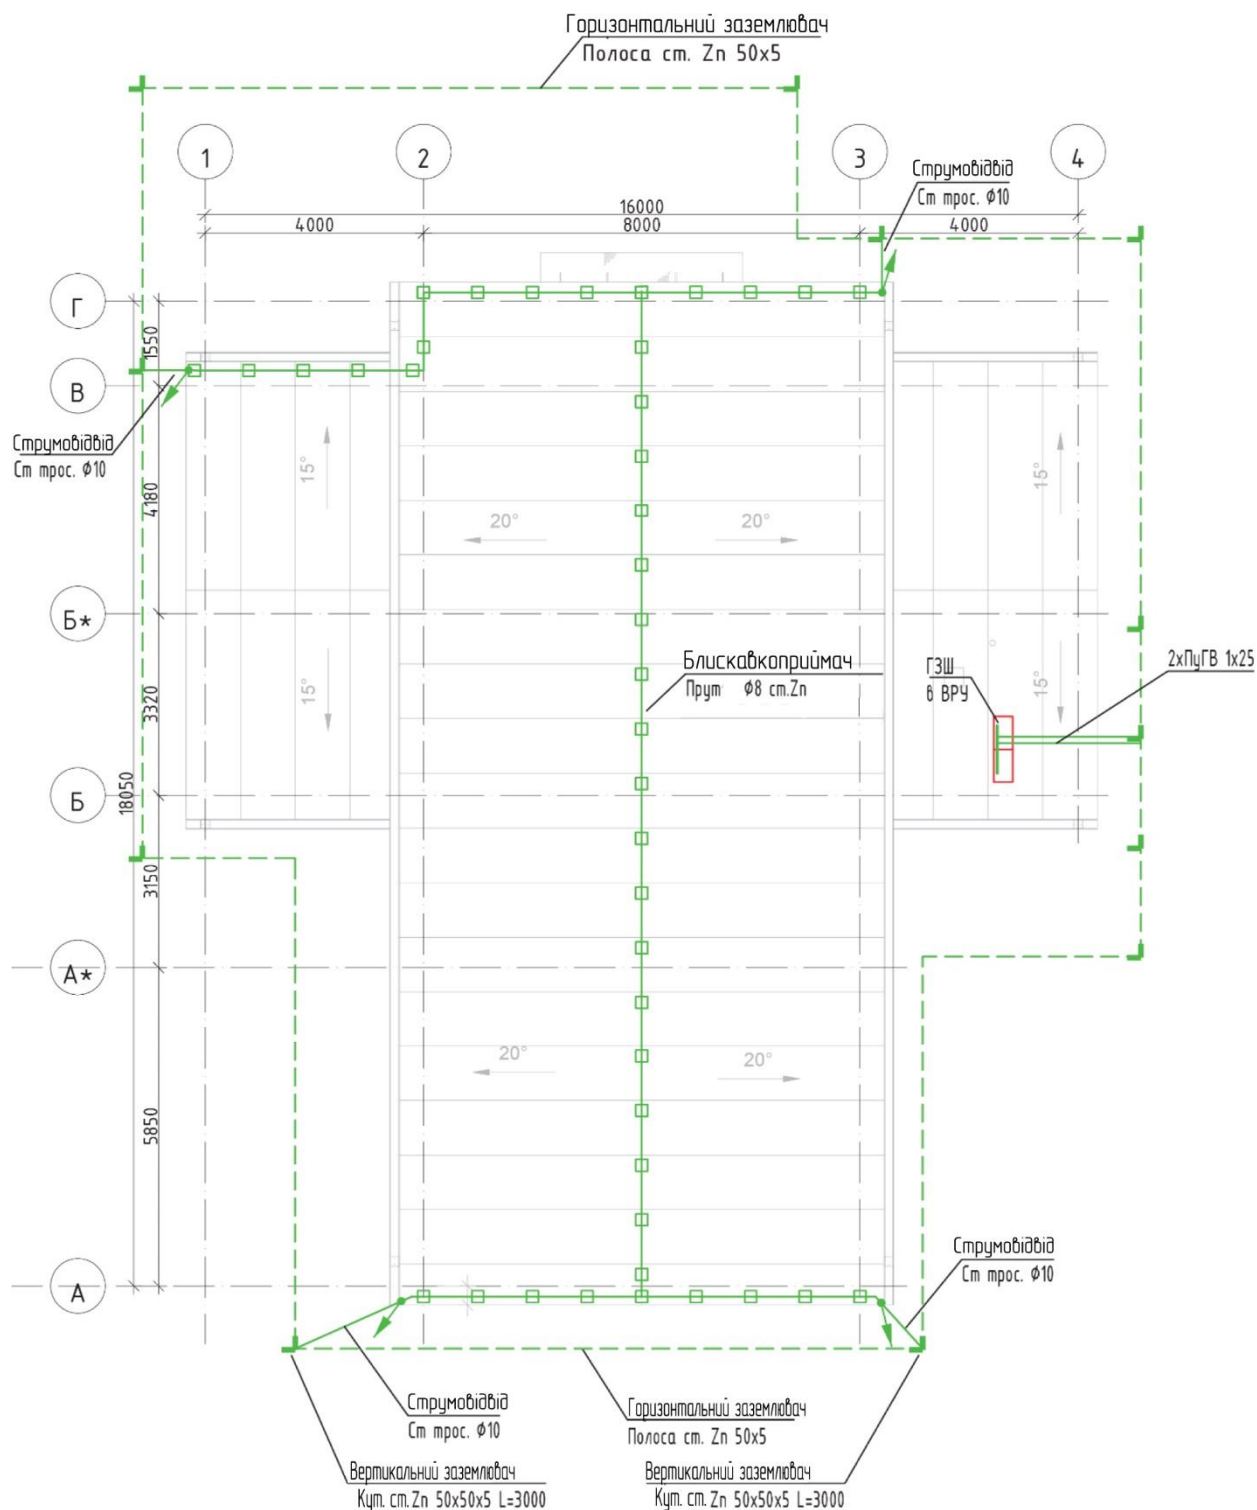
План заземлення та блискавкозахисту будівлі.
